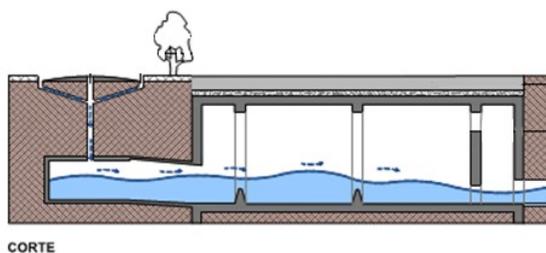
Bacia de retenção enterrada. Fonte: CANHOLI, 2014
